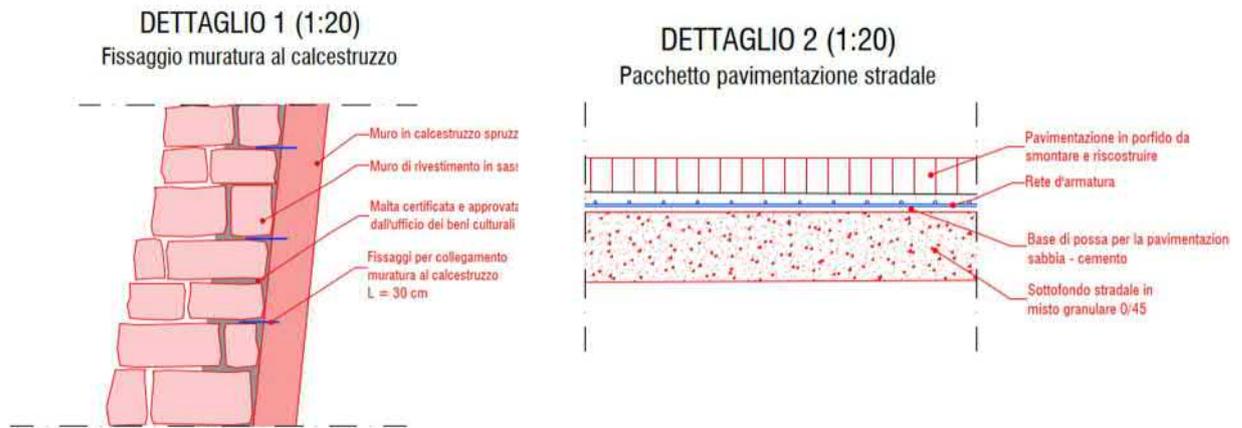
Dettagli collegamento muro di rivestimento e pavimentazione
